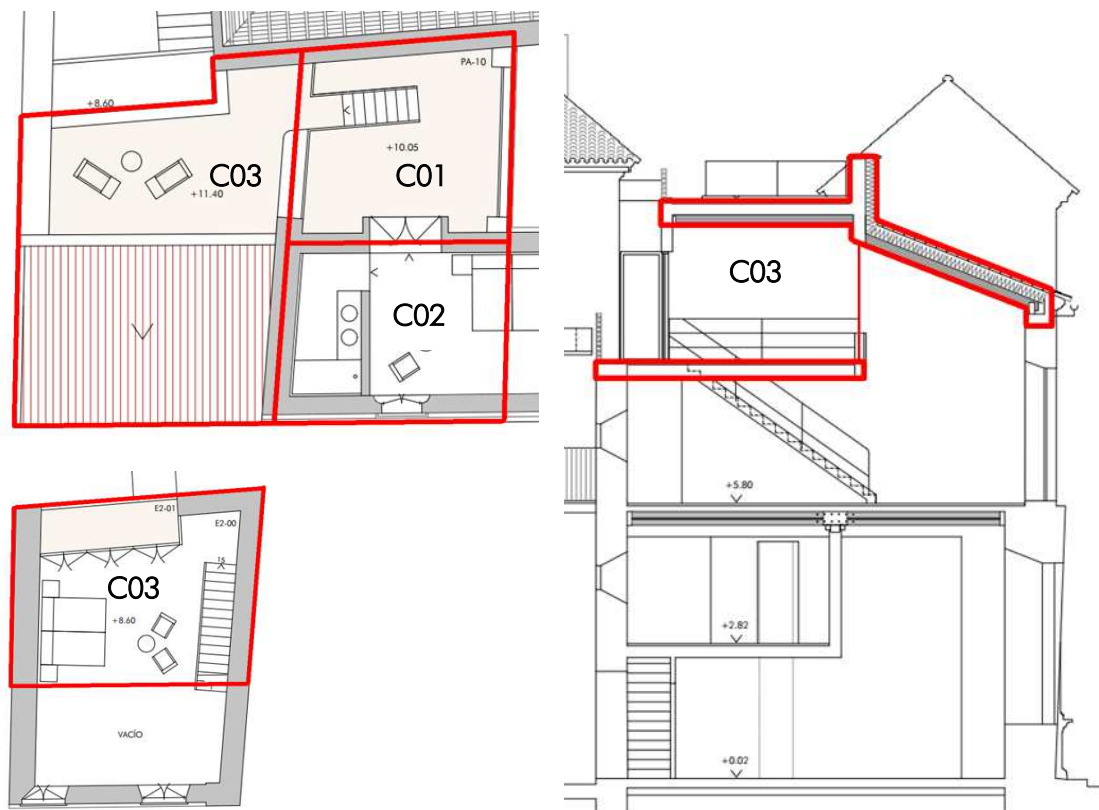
Identificación de modelos en planimetría del proyecto. De izquierda a derecha y de arriba a abajo; planta de cámaras, entreplanta de unidad de alojamiento y sección por ésta última.
